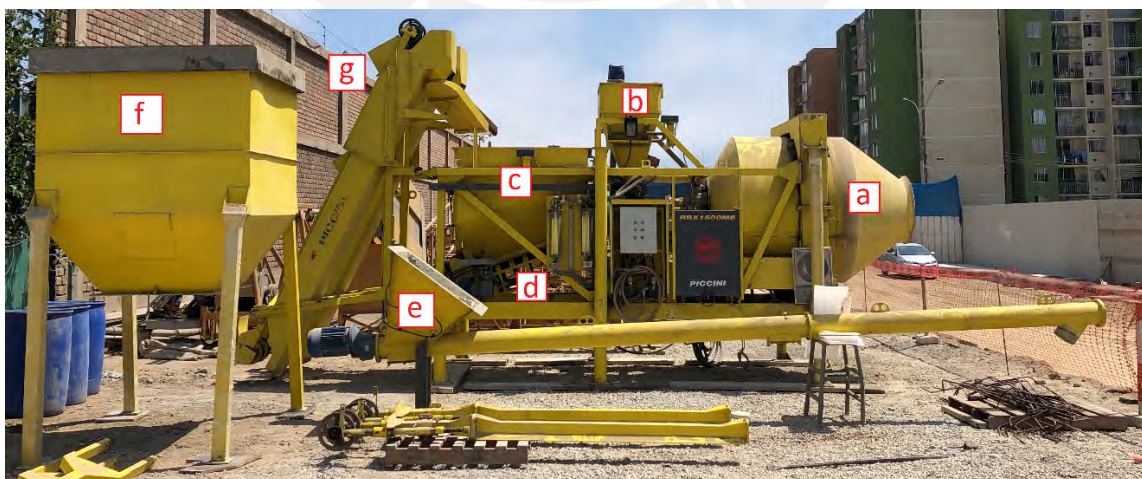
Componentes y accesorios de la planta de concreto Piccini RBX 1500
